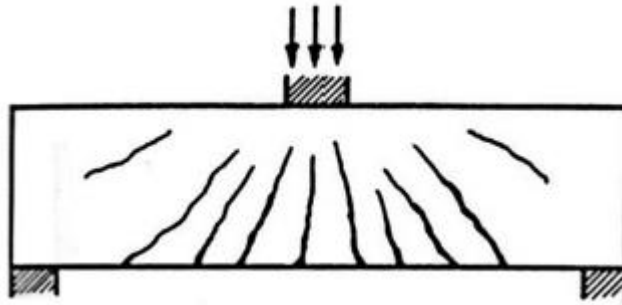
Fisuras en una viga sometida a flexión en la rotura
